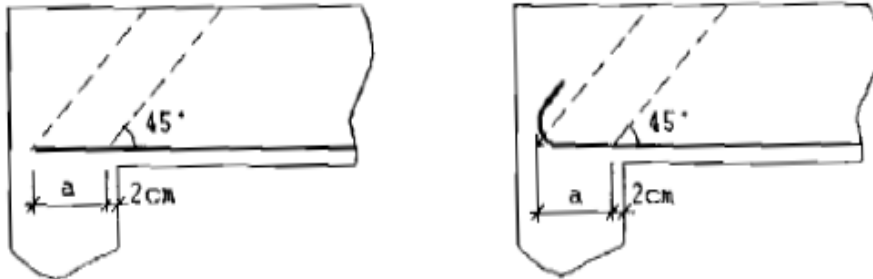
Largeur de bielle « poutre solidaire d'un poteau » [1]
